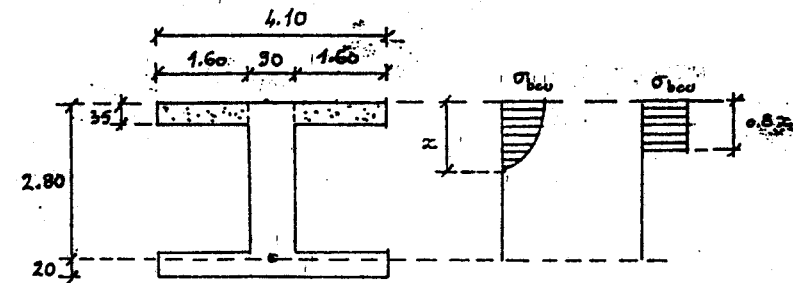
Section de la poutre et diagramme des contraintes en ELU
